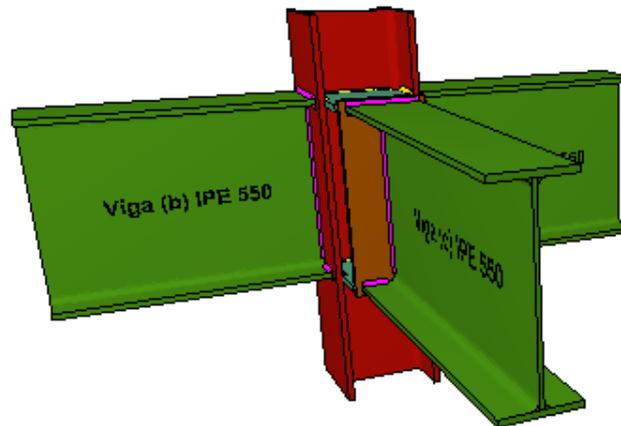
Soldadura S5. Fuente: CYPE 2017
